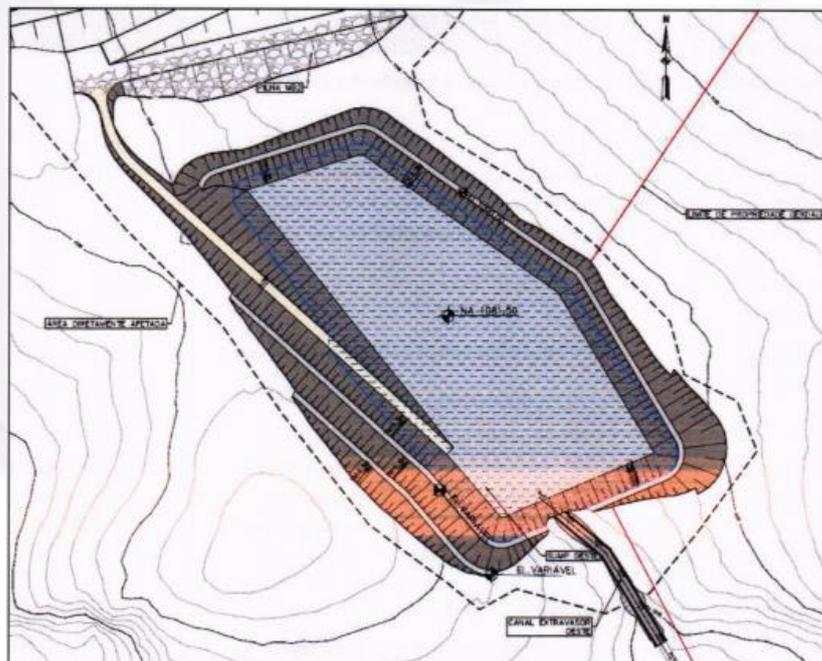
Planta Sump Oeste. Fonte: BVP, 2019
